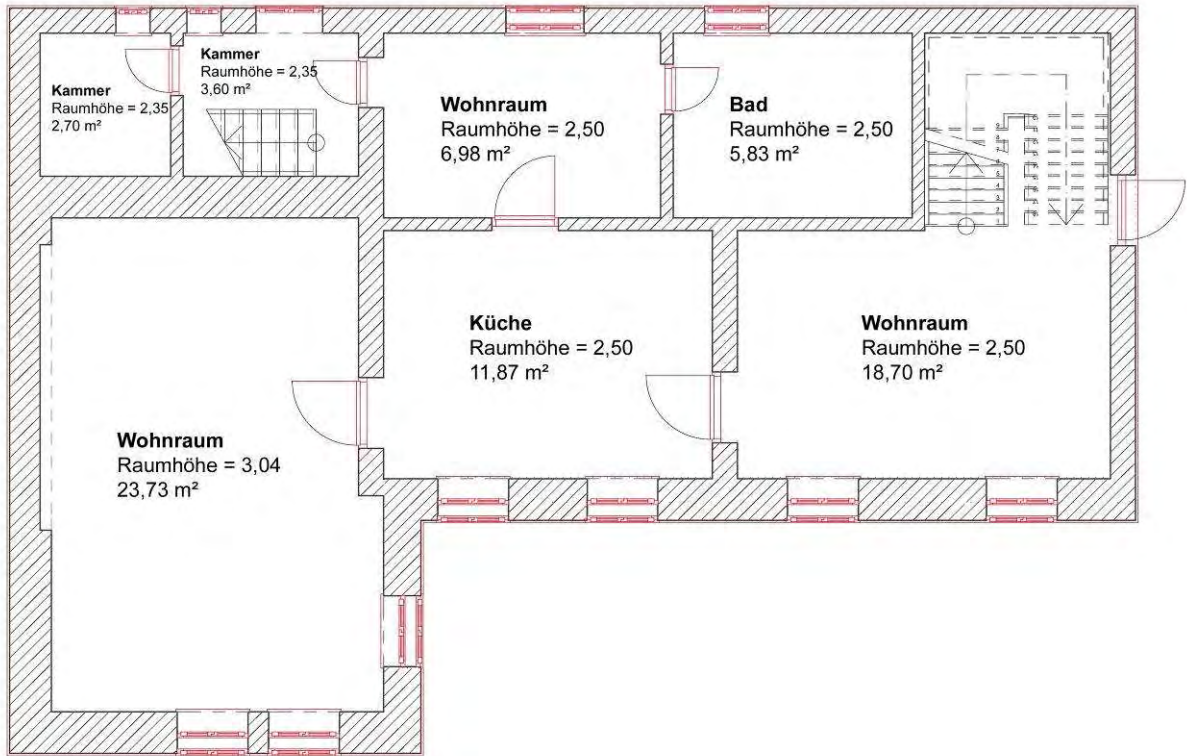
Grundriss Erdgeschoß (Bestand)
